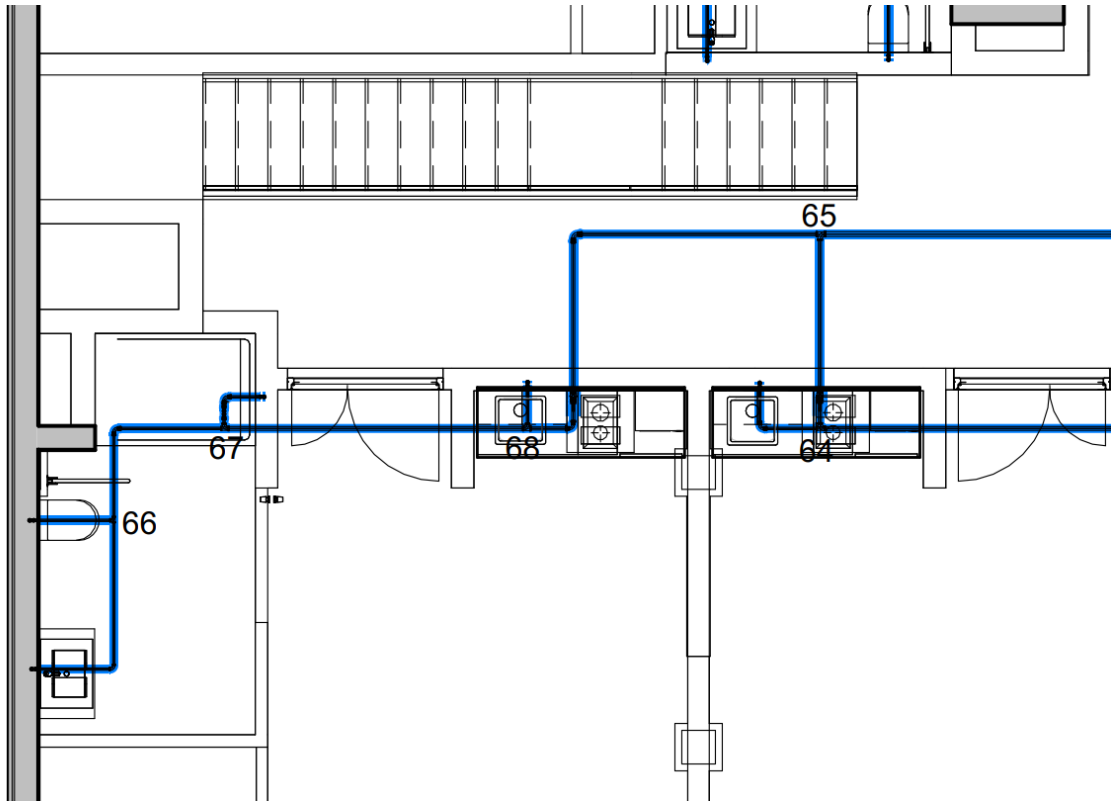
Recorte extraído de los planos de fontanería numerados.
